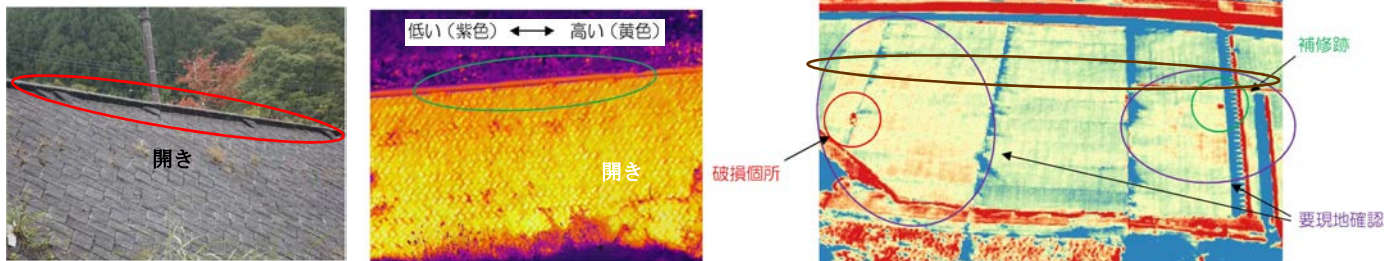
コンクリート護岸の UAV 画像と UAV レーザスキャナ断彩図
